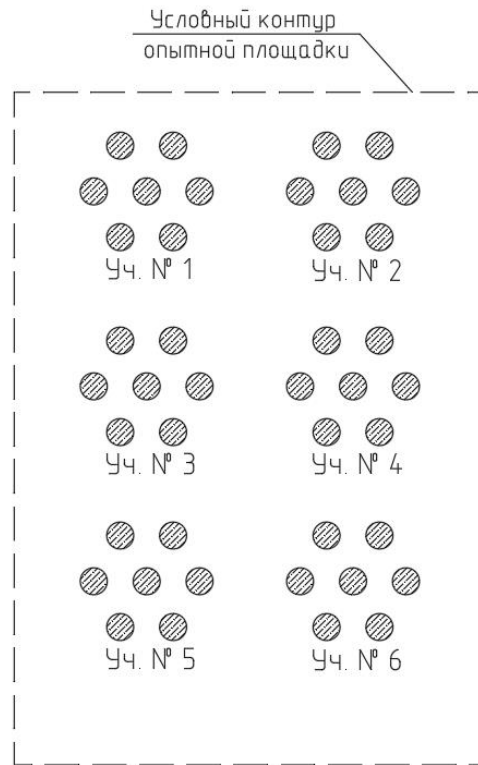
Схема расположения участков армирования грунтового массива ГЦЭ на опытной площадке
